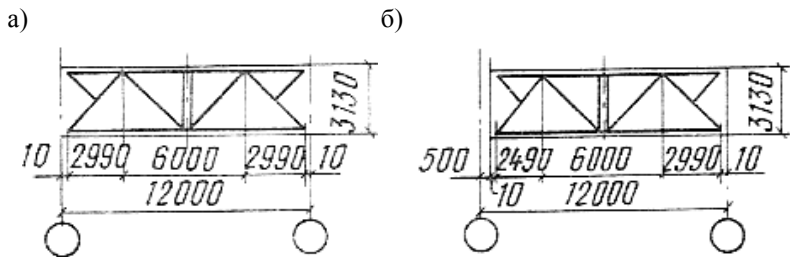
Подстропильные фермы нормальной высоты пролетом 12м:
